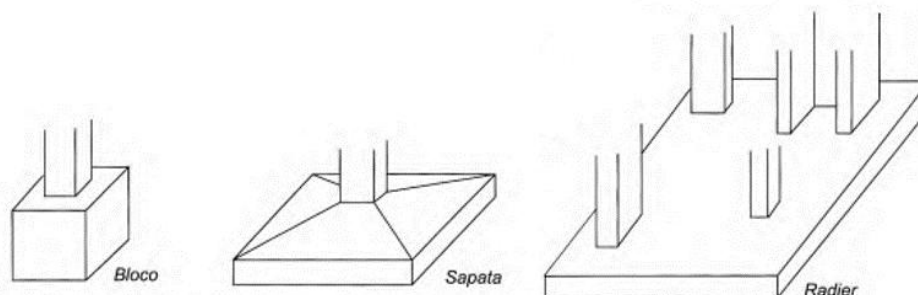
Principais tipos de fundações superficiais (Adaptado de Velloso e Lopes, 2010)
